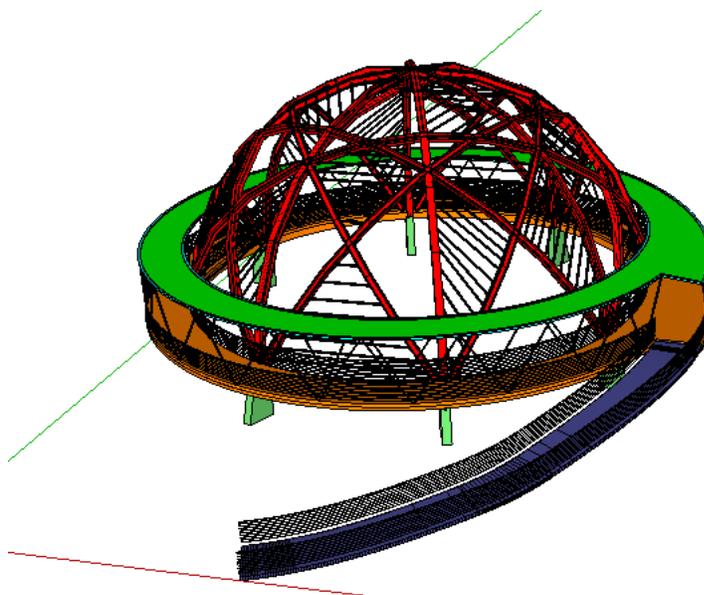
Proceso de levantamiento de estructura de domo central. Fuente Elaboración propia
